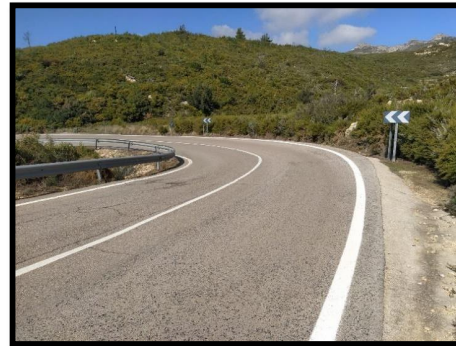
Panel de balizamiento existente. Fuente: Elaboración propia.
